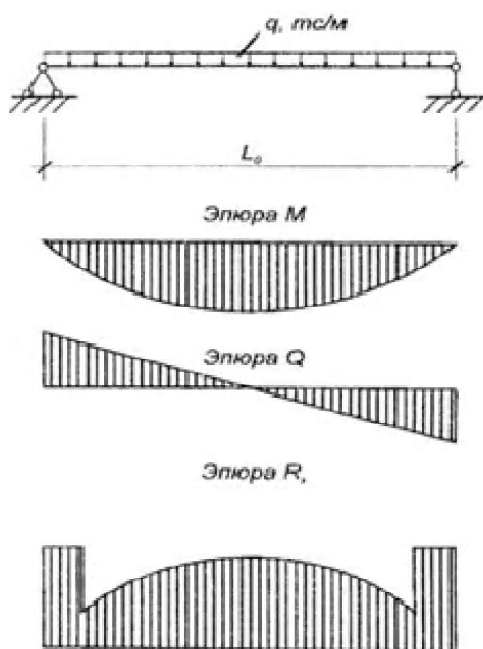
Расчетные и контрольные эпюры для однопролетной железобетонной балки.
